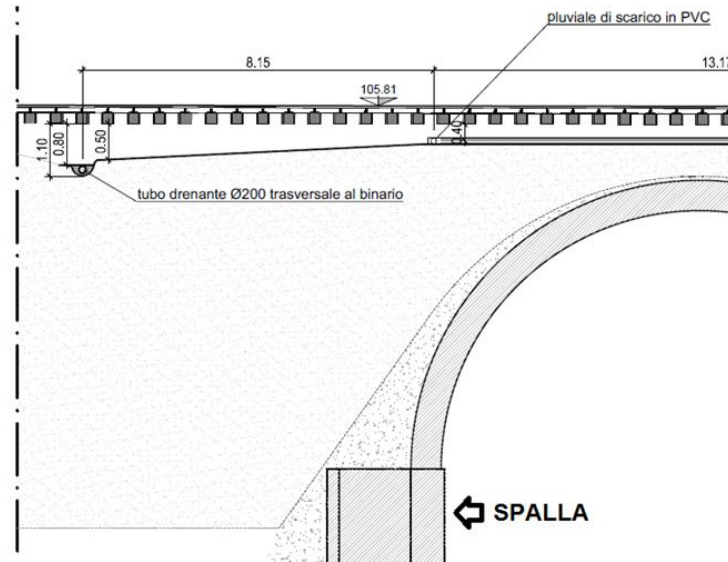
b - Trincea a monte della spalla con tubo corrugato trasversale del diametro minimo di 200mm
